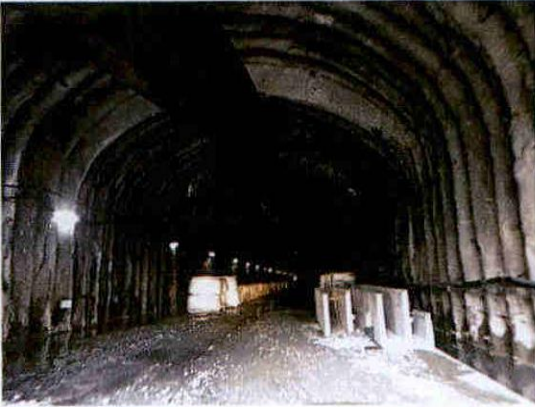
UF3 – Tubo norte	Foto 22. UF3 – Tubo sur
